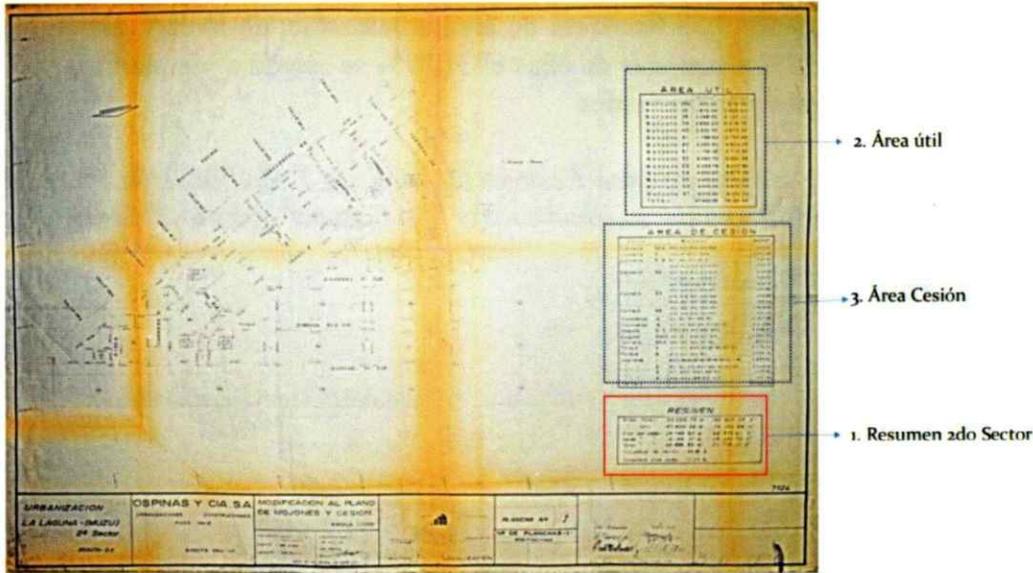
Análisis Cuadro de Área Útil / Cesión, plancha 2 de 2 del plano B4/4 1er sector denominado: “PLANO DE MOJONES Y CESIONES DE ZONAS”.
